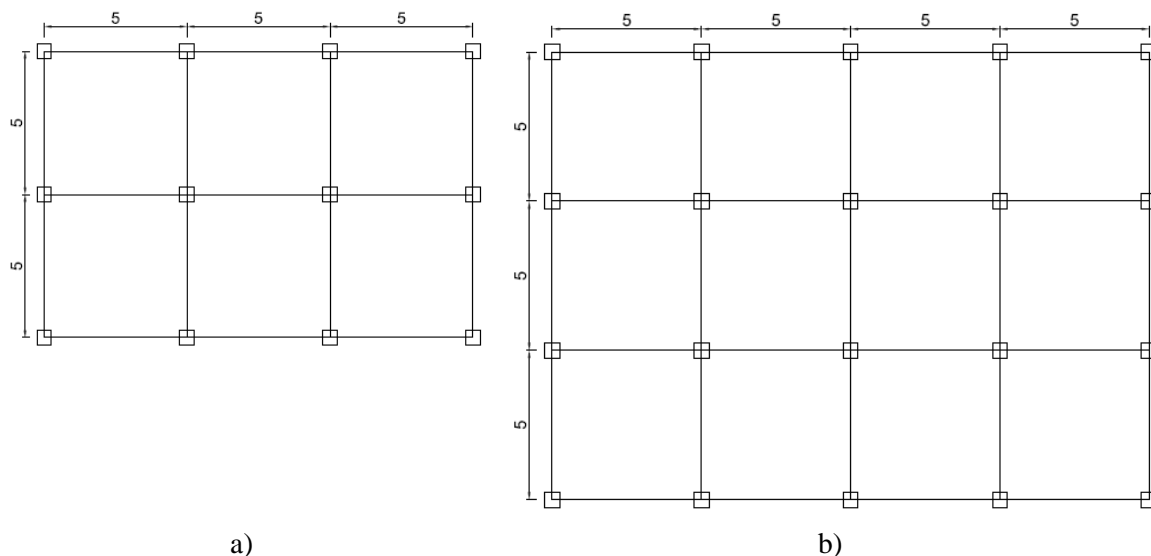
Vista en planta de edificaciones: a) 6 y 8 niveles b) 10 y 12 niveles (Sin escala)
